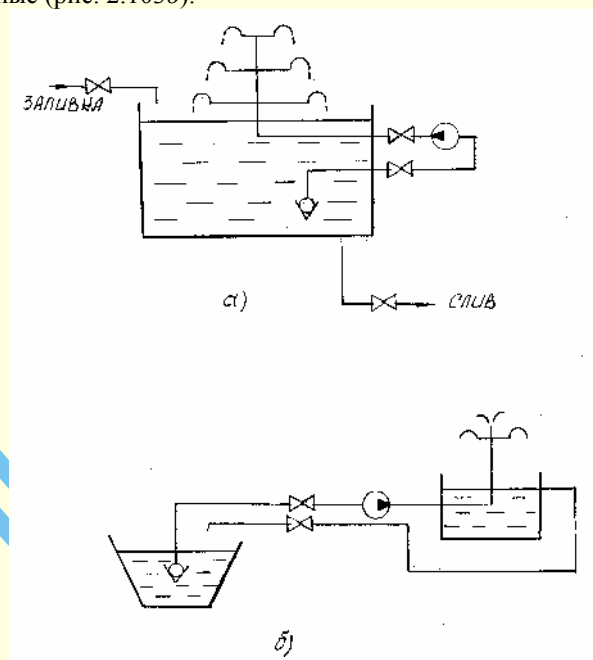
Установки для фонтанов: а — оборотная; б — прямоточная
